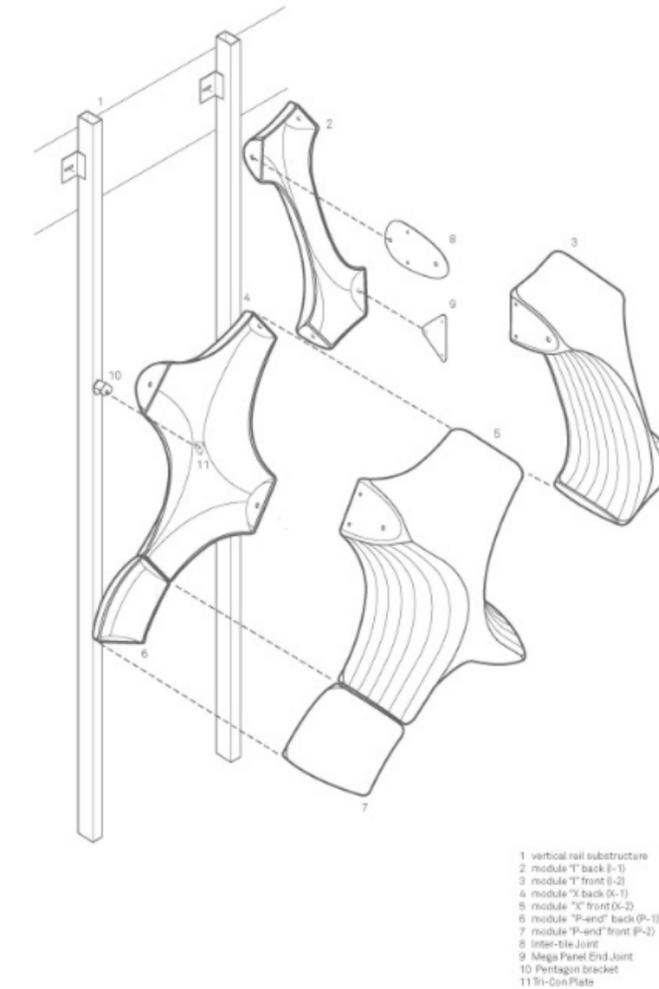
Detalle de un panel prosolve370e y su instalación en una falsa fachada.
